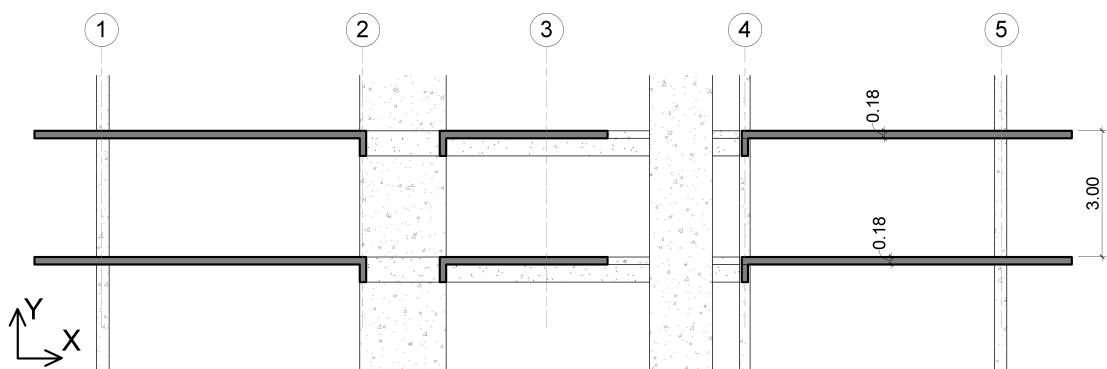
Corte A - Pavimento tipo - Modelos C e D - Unidades em metro.
